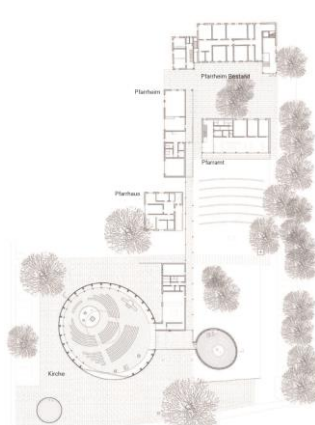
Grundriss Entwurf Eberhard Wimmer
